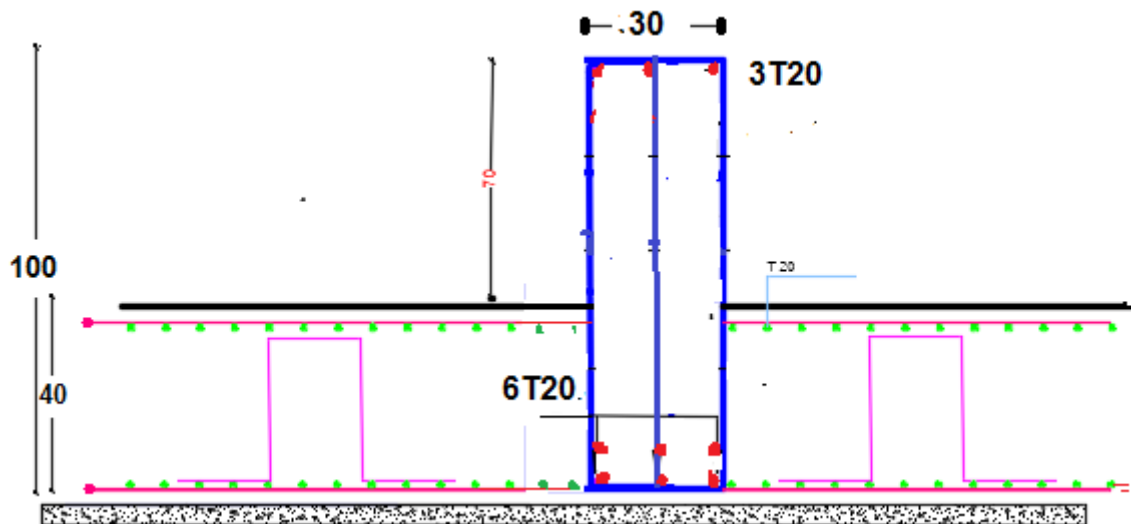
dessin de ferrailage d'une poutre principale en travée.
